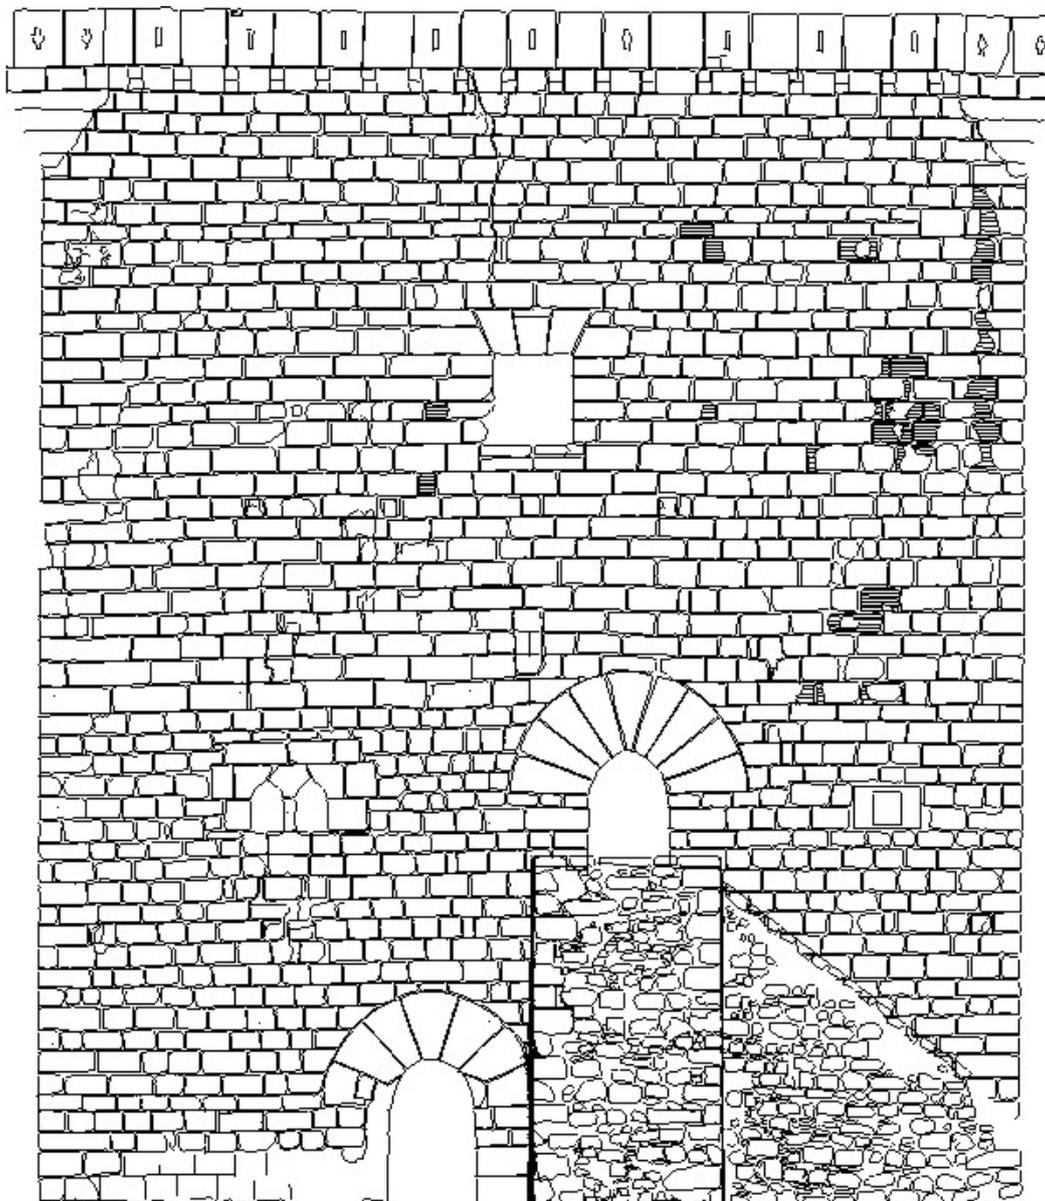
Restitución del exterior de la torre (Alzado Sur)
